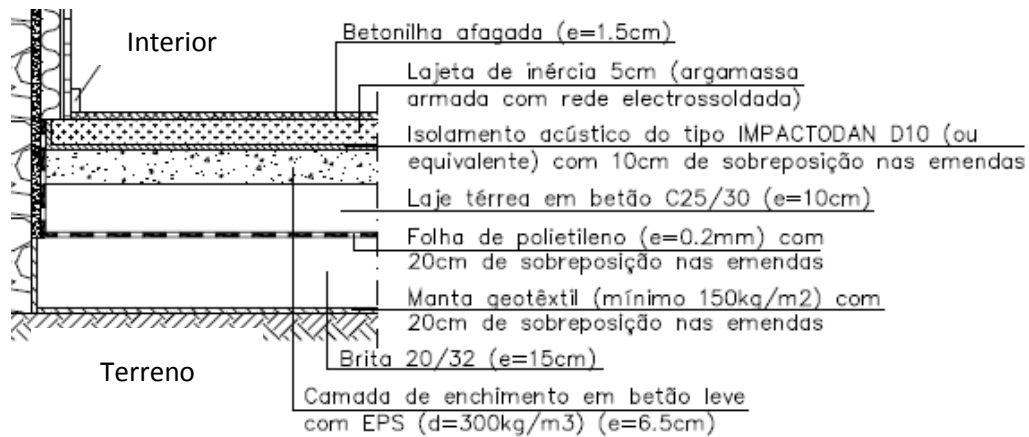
Pormenor construtivo do piso térreo [17]
